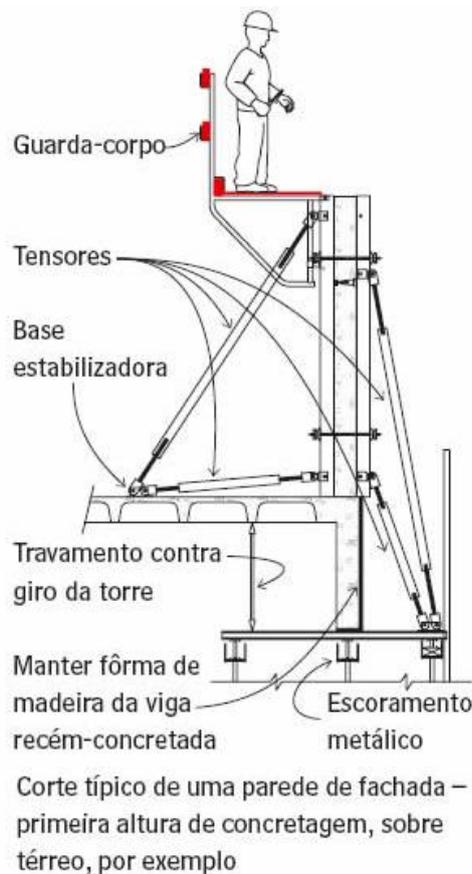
Processo de montagem e fixação dos andaimes e guarda-corpos para execução das paredes de concreto.
